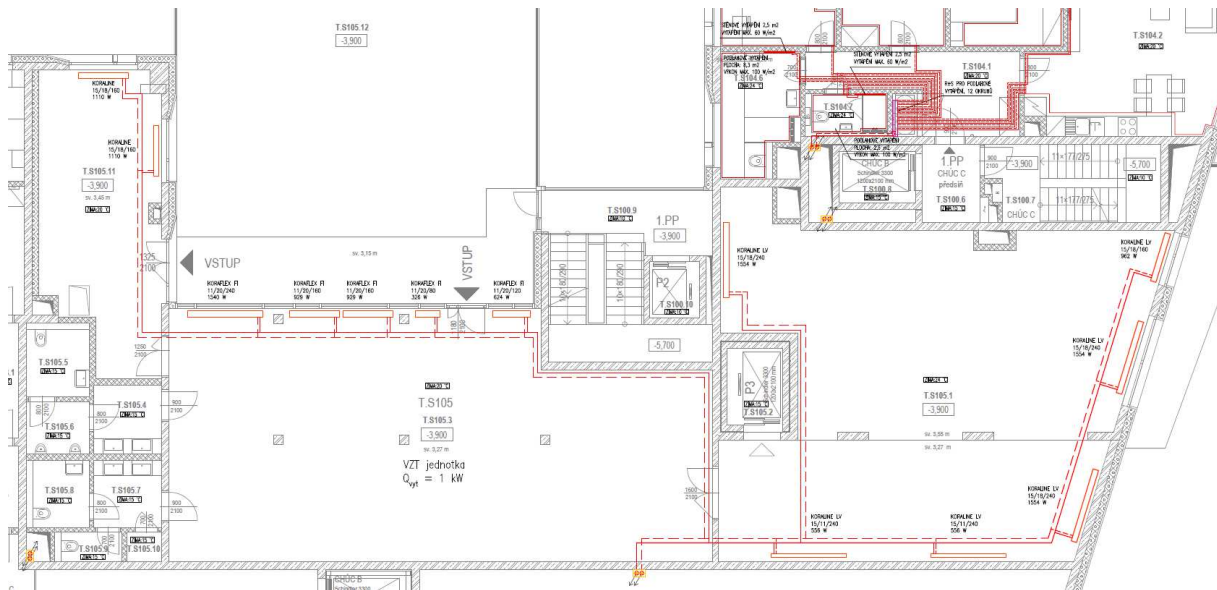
Půdorys dvou obchodních jednotek 2.PP
